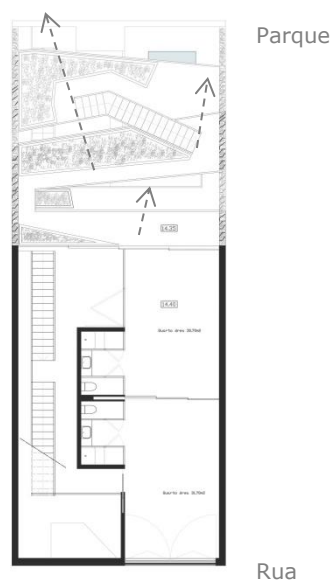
Planta do Piso 2 e Sistema de Vistas
